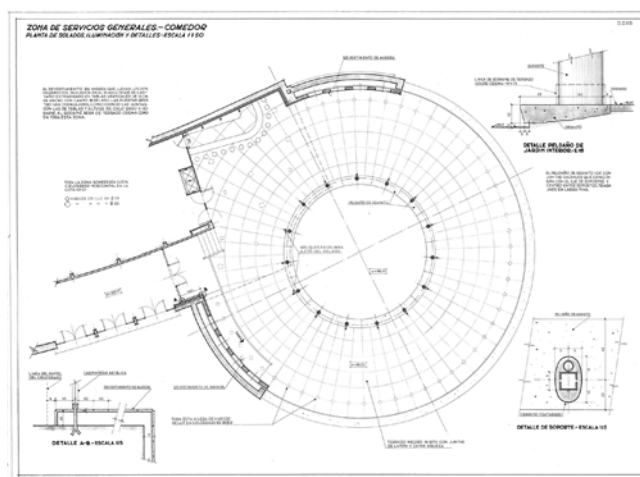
Planta de solados. Comedor (Archivo IETCC).
